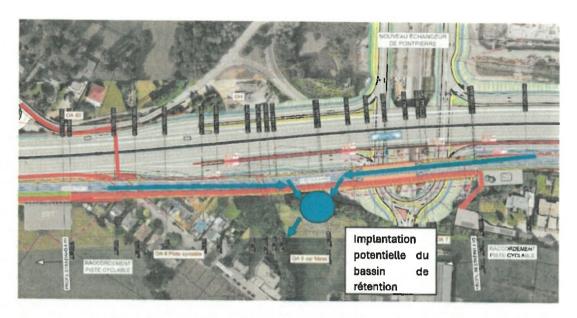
plan de localisation SST Pontpierre au PK 7800 (fait défaut sur d'autres plans)
